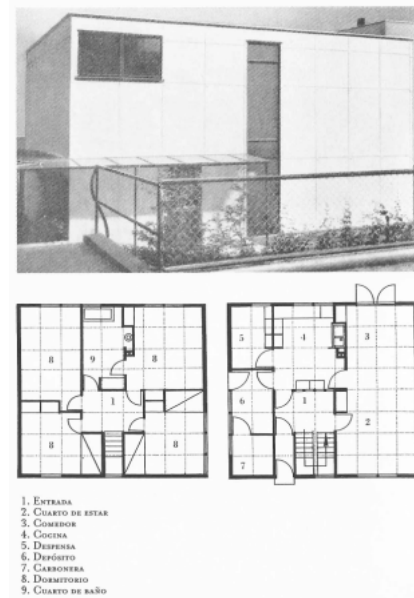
Casa experimental en la Weissenhof, Stuttgart, 1927, vista, planta primera y baja.. Walter Gropius.
